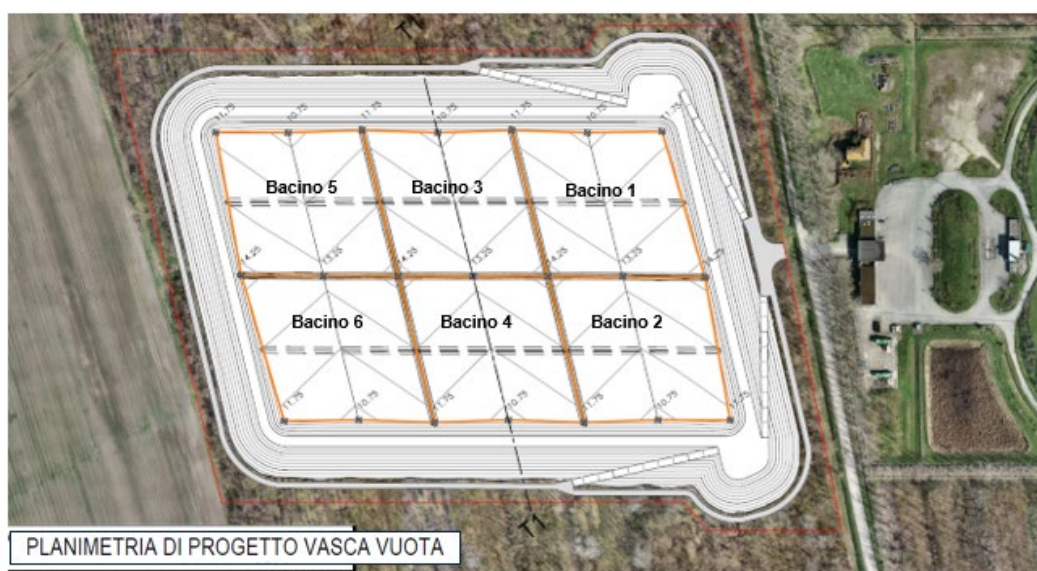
Planimetria generale dello stato di progetto, vasca vuota
